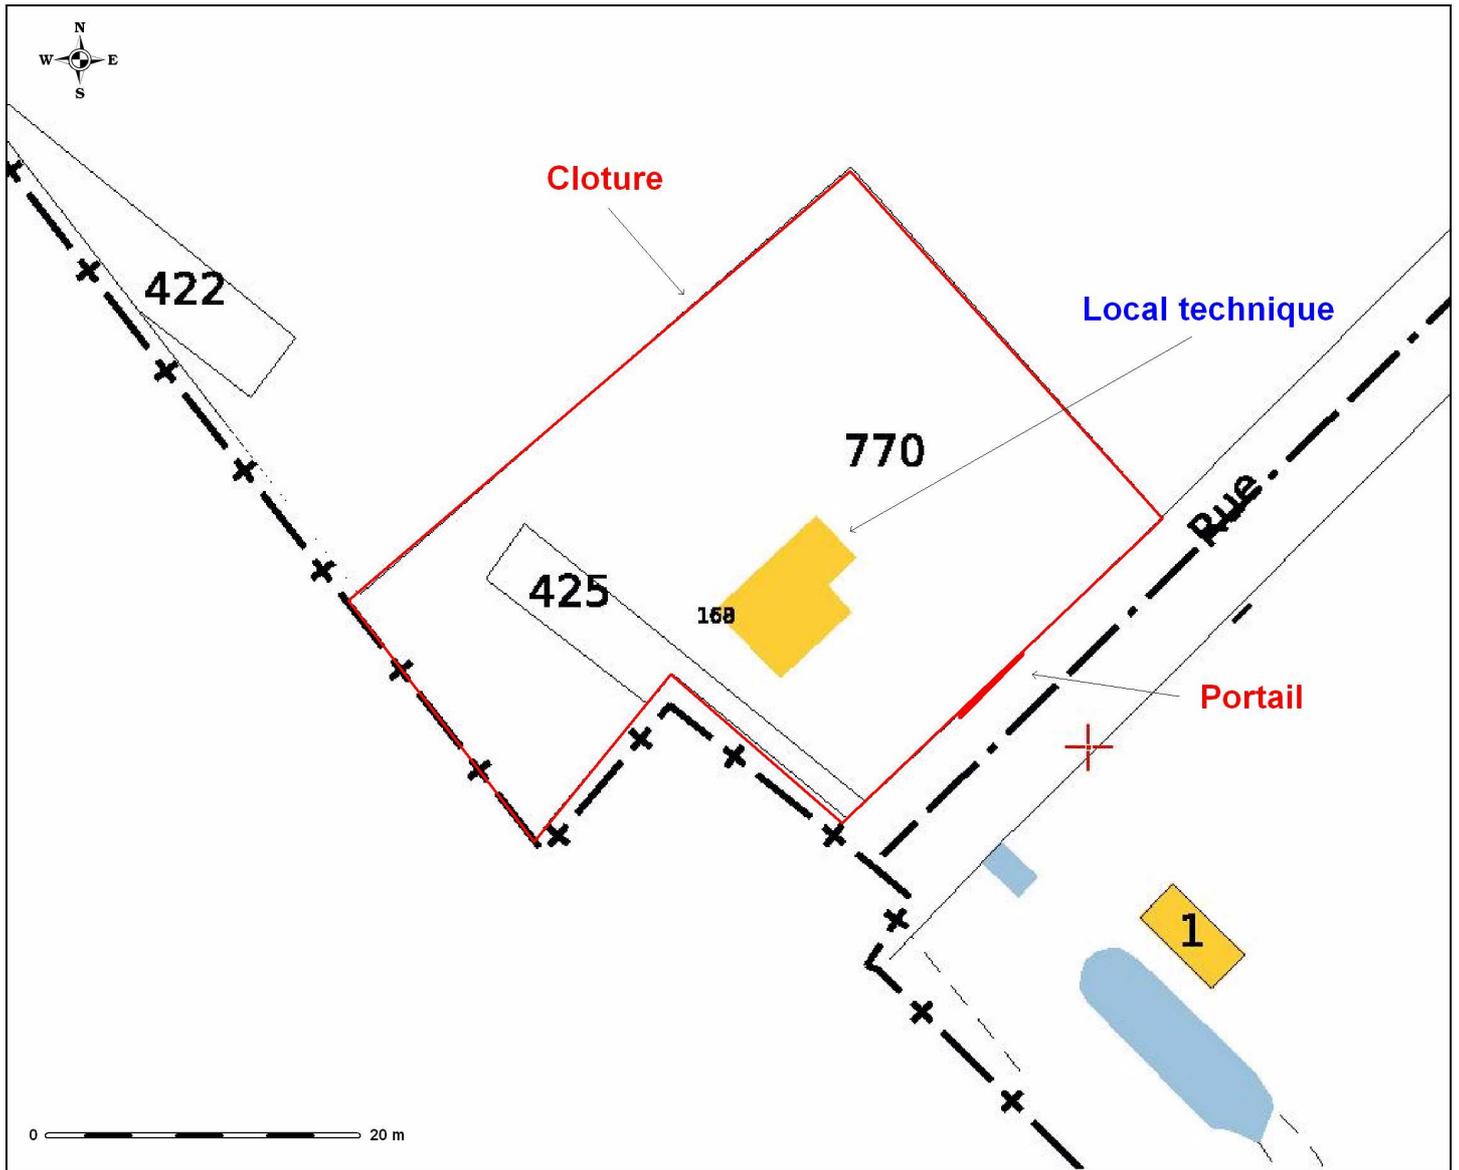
Localisation du captage de Vauréal sur fond de plan cadastral (2007)
